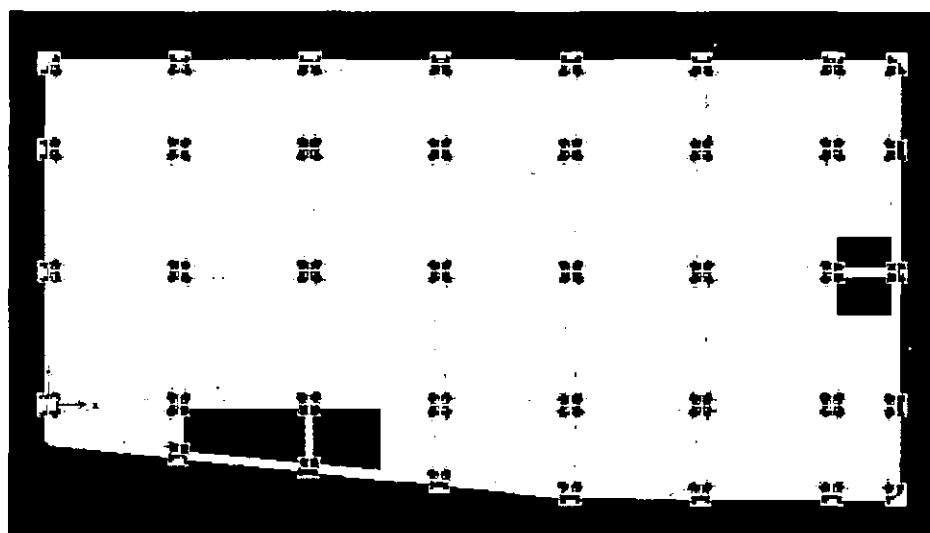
Plata de aislamiento superior (capiteles y vigas de aislamiento superior).
